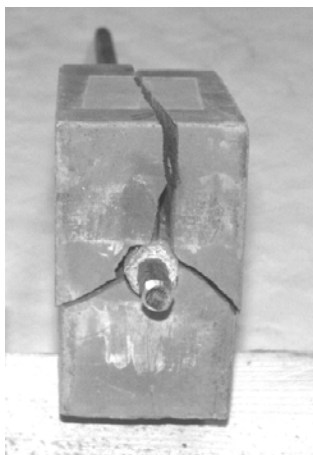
Schlagartiges Aufspalten der senkrecht zur Betonierichtung belasteten Prüfkörper
